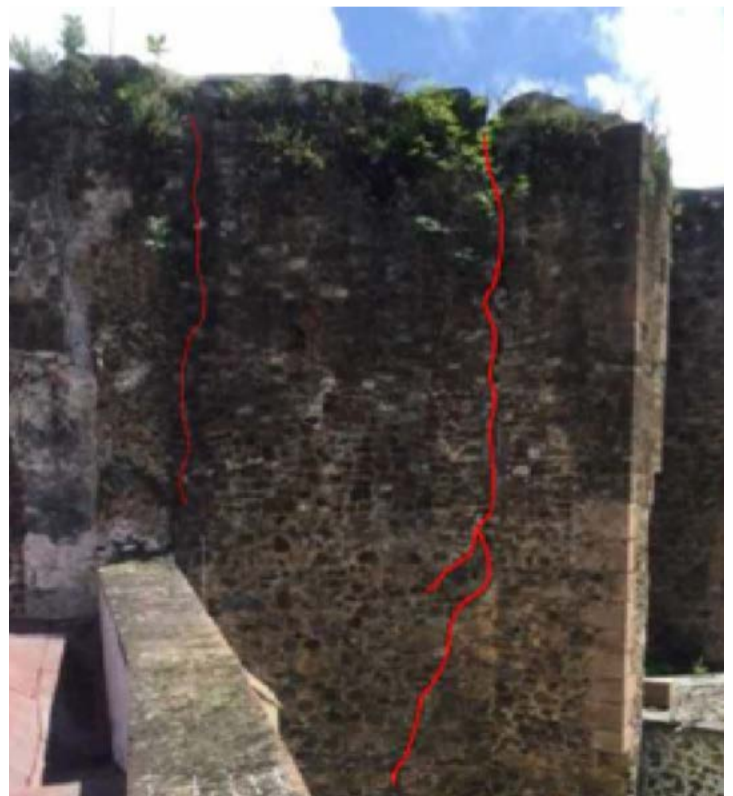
Muro de la exnave del templo colapsado después del sismo.
